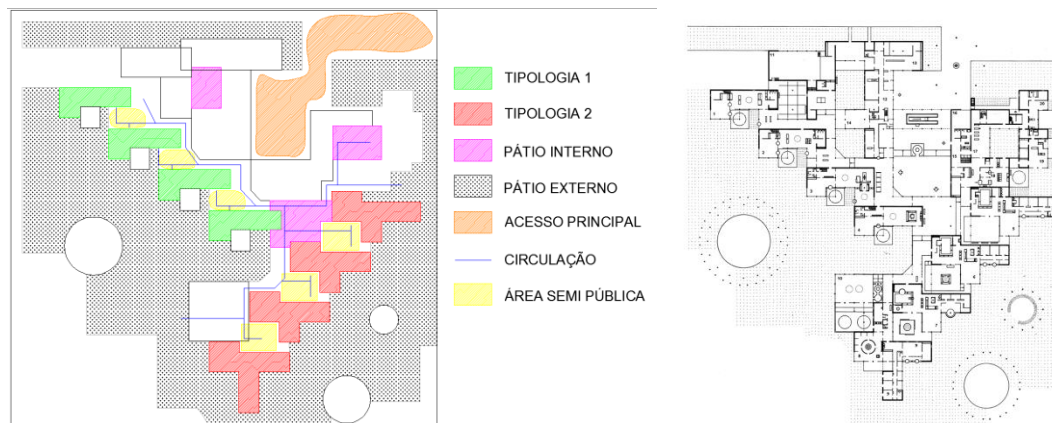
O Orfanato, Análise Planta Baixa - Fonte: Google imagens.
